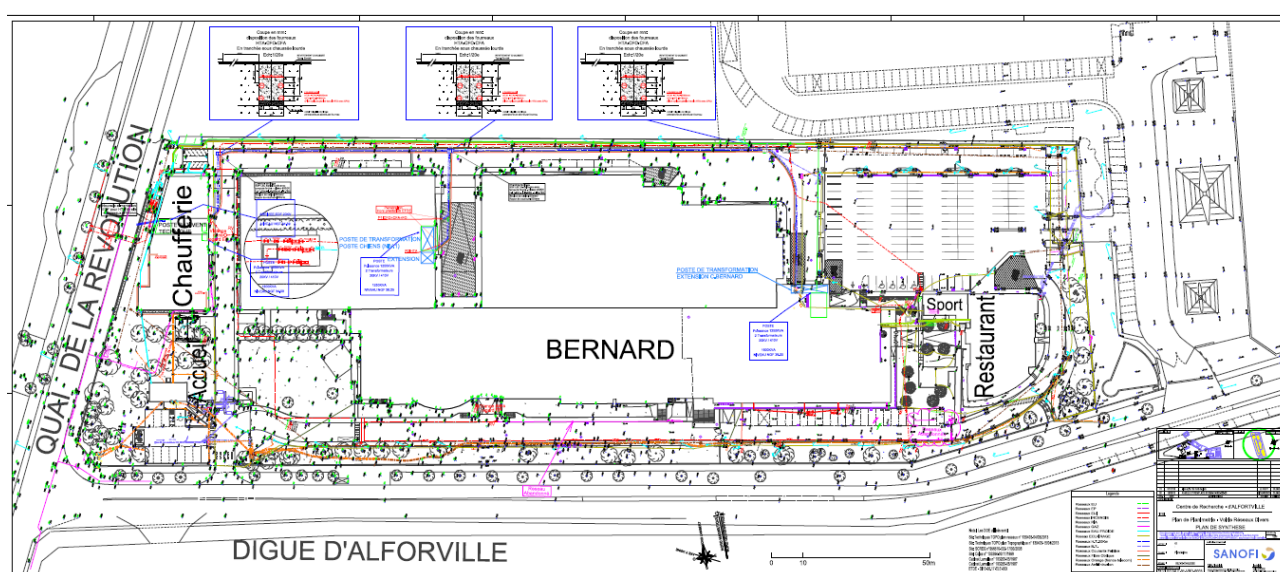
Plan des réseaux internes (source : plans SANOFI)
